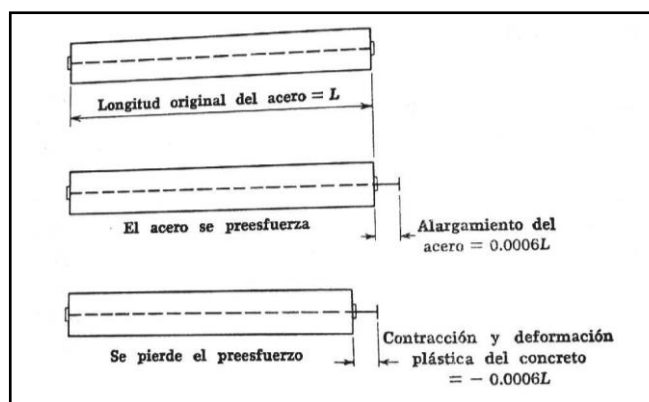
Presfuerzo del concreto con acero estructural ordinario.
